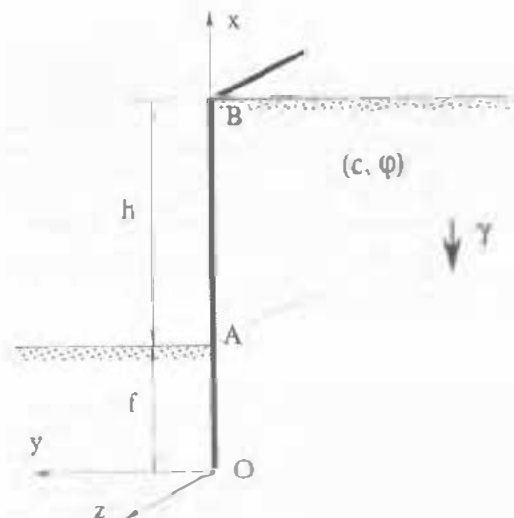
Stabilité d'une excavation à l'abri d'une paroi verticale.
